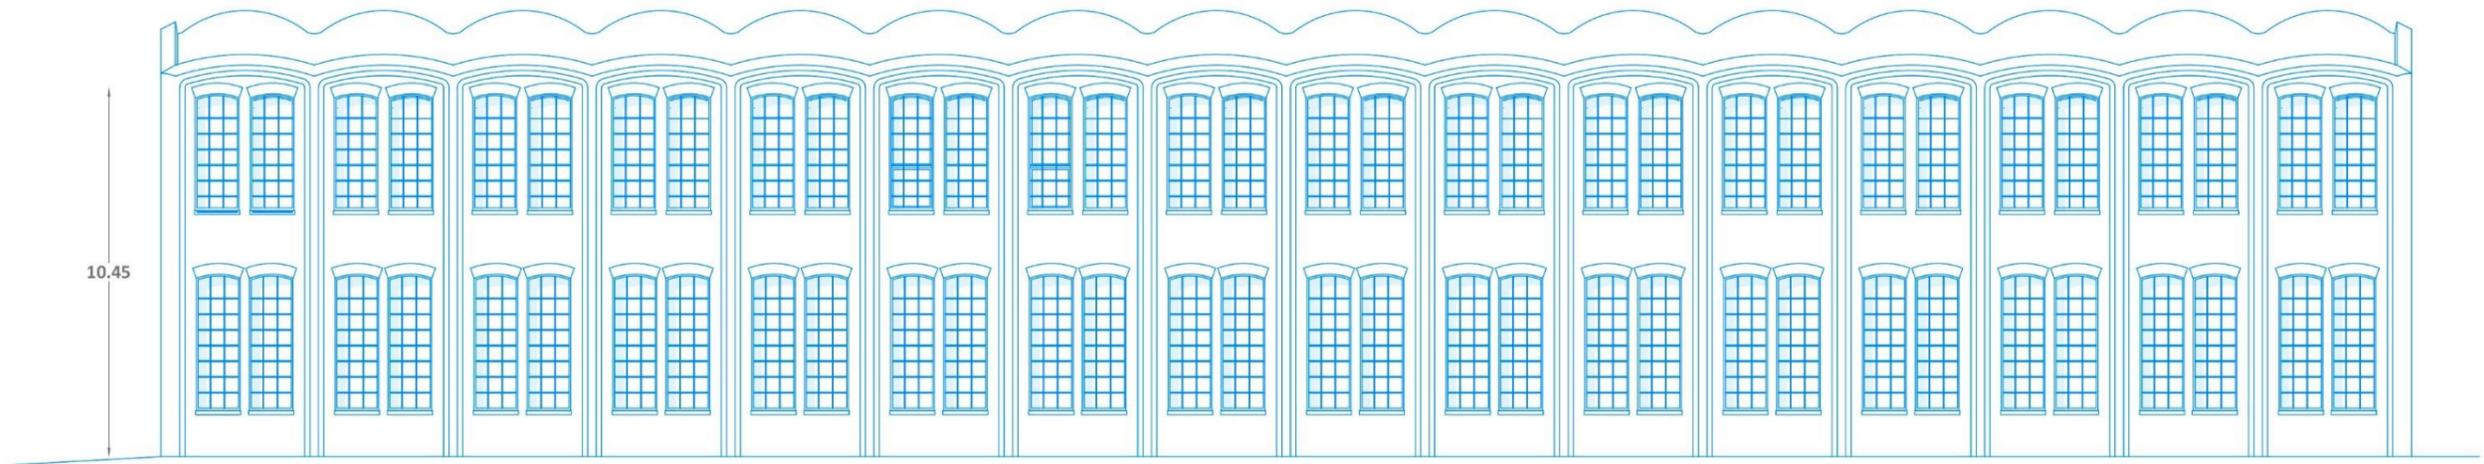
PLANO 1/200. Alzado pre intervenció nave original fàbrica Pere Font i Batallé.
